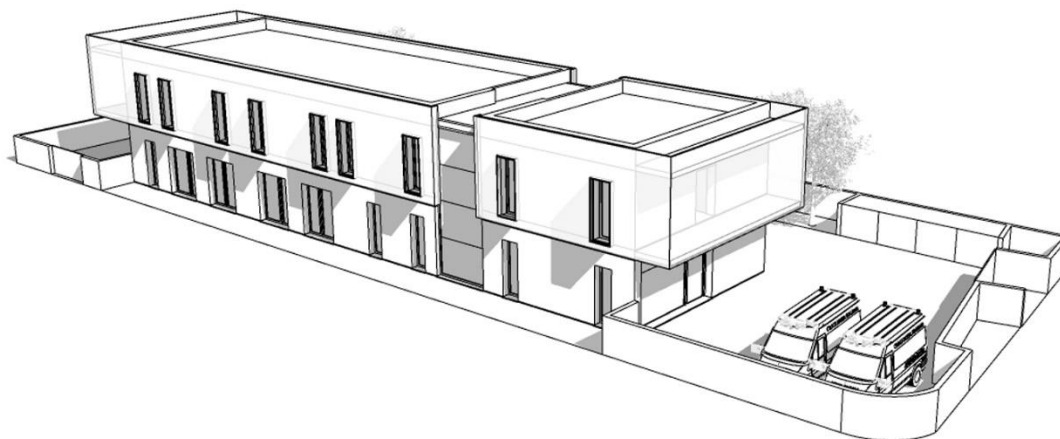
schizzo di progetto preliminare Nuova Sede Croce Rossa di Pontasserchio vista sud-ovest
